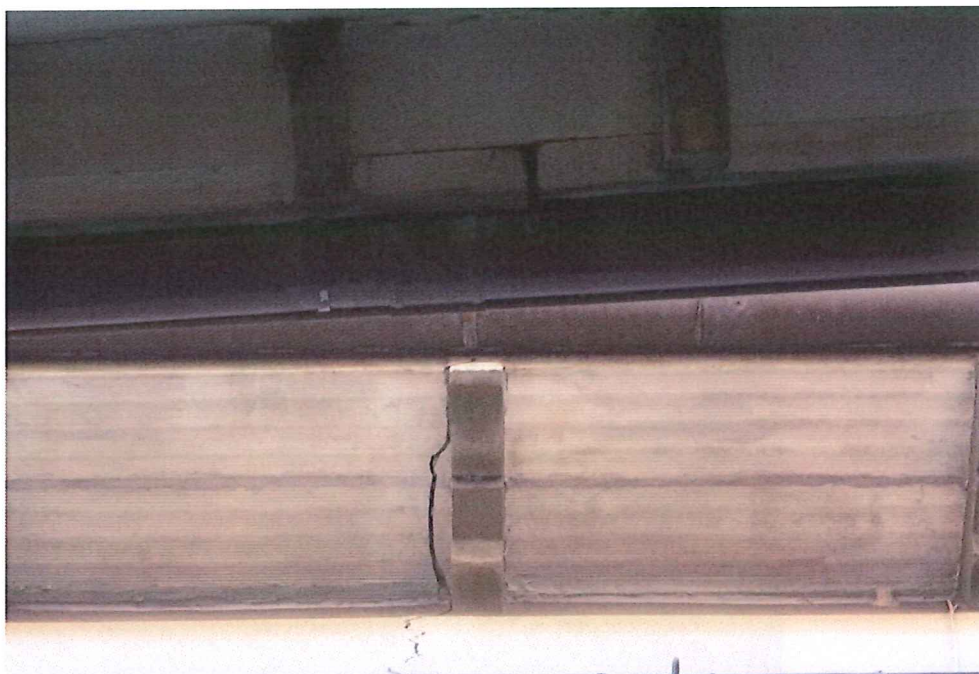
= Prospetto sulla corte interna – Dettaglio lesione nei tavelloni di coperto
